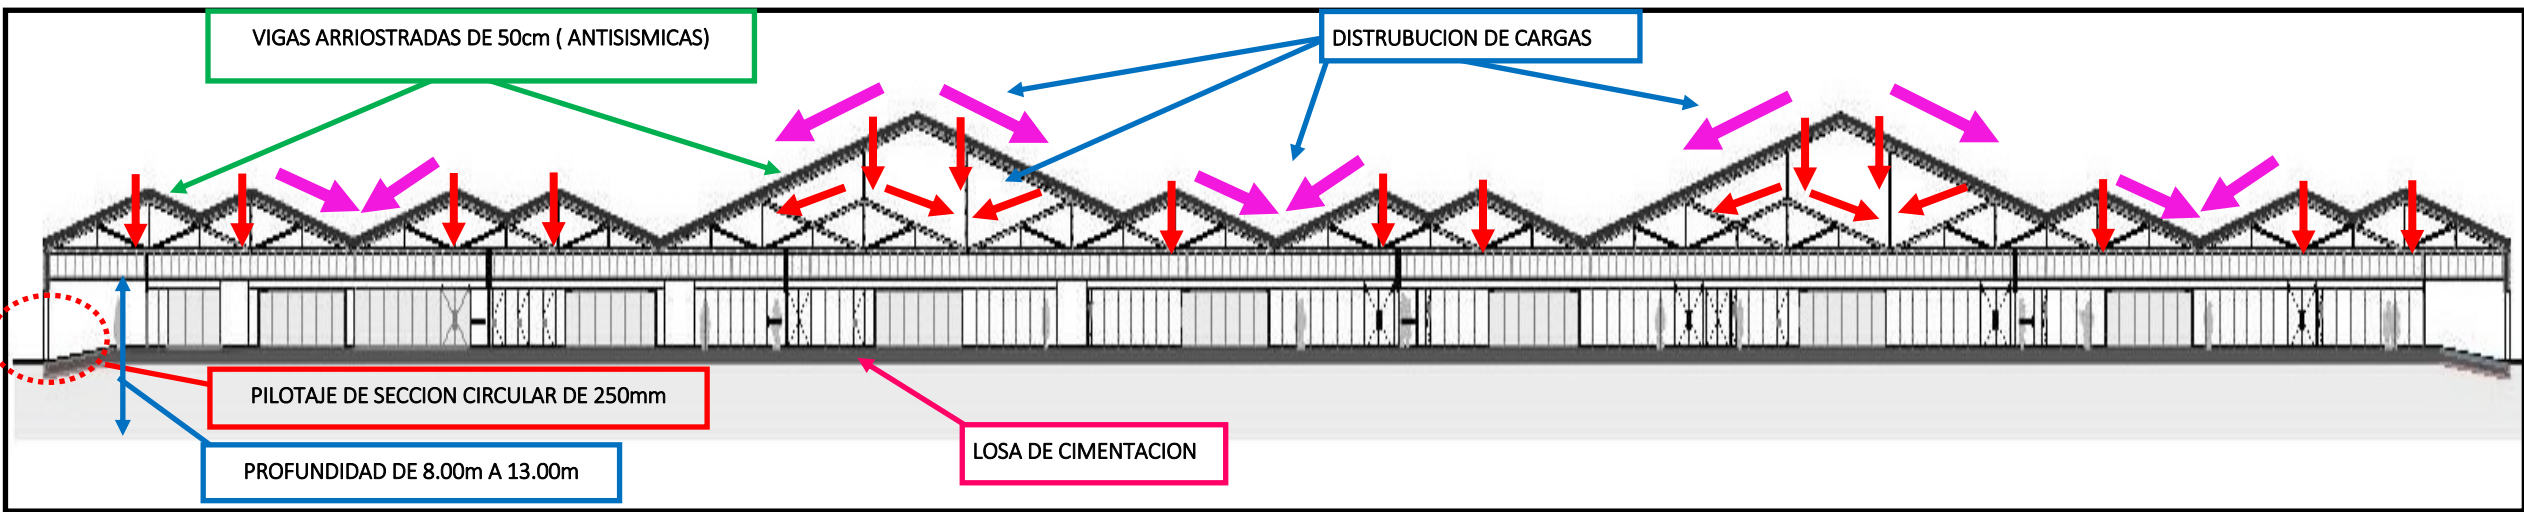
CORTE LONGITUDINAL DE ESTRUCTURA DE FACHADA PRINCIPAL
